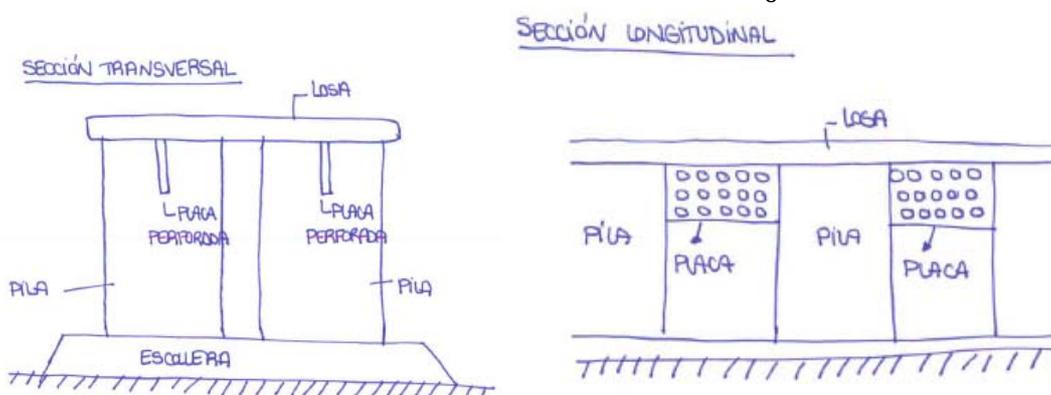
Secciones longitudinal y transversal del espigón
